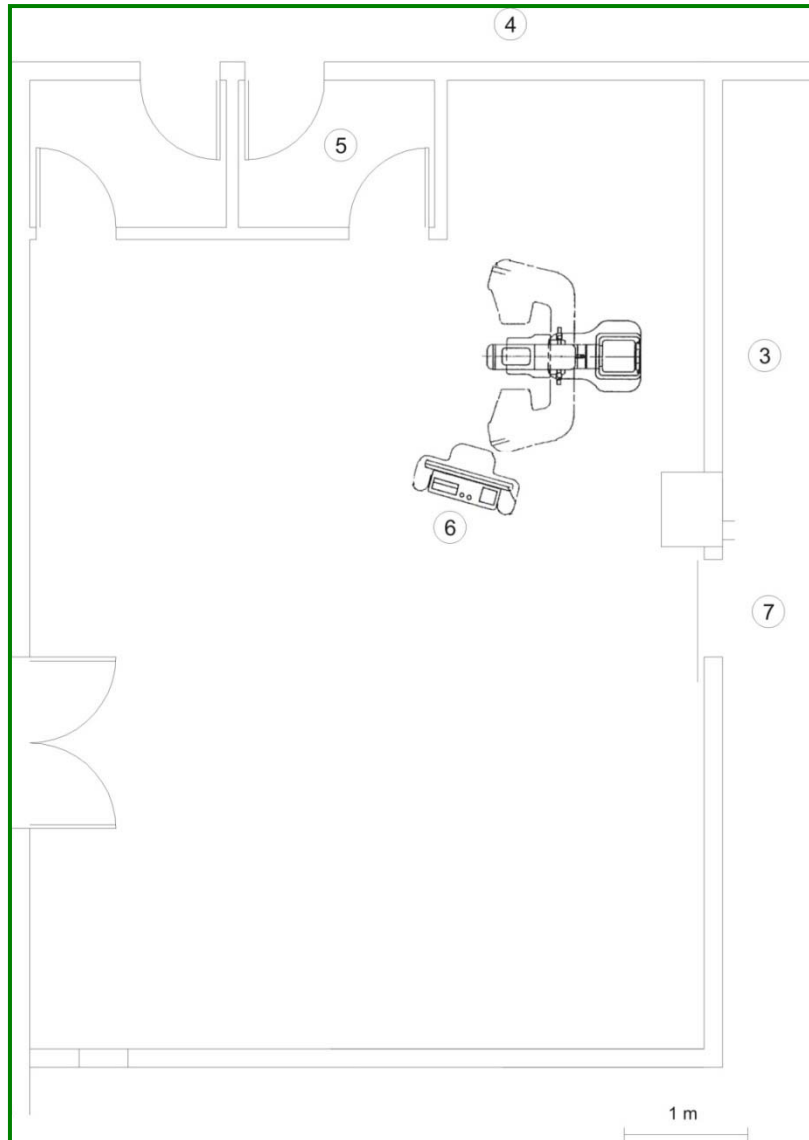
Planta arquitectónica da sala de Mamografia (Sala 1).
